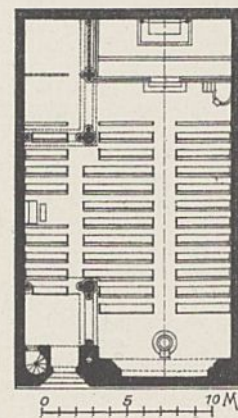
Grundriss zu Abb. 1 u. 2.
